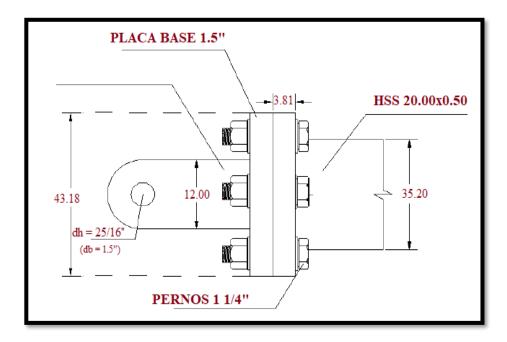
Detalle 02 Conexión brazo metálico - barra de conexión. Fuente: Propia
